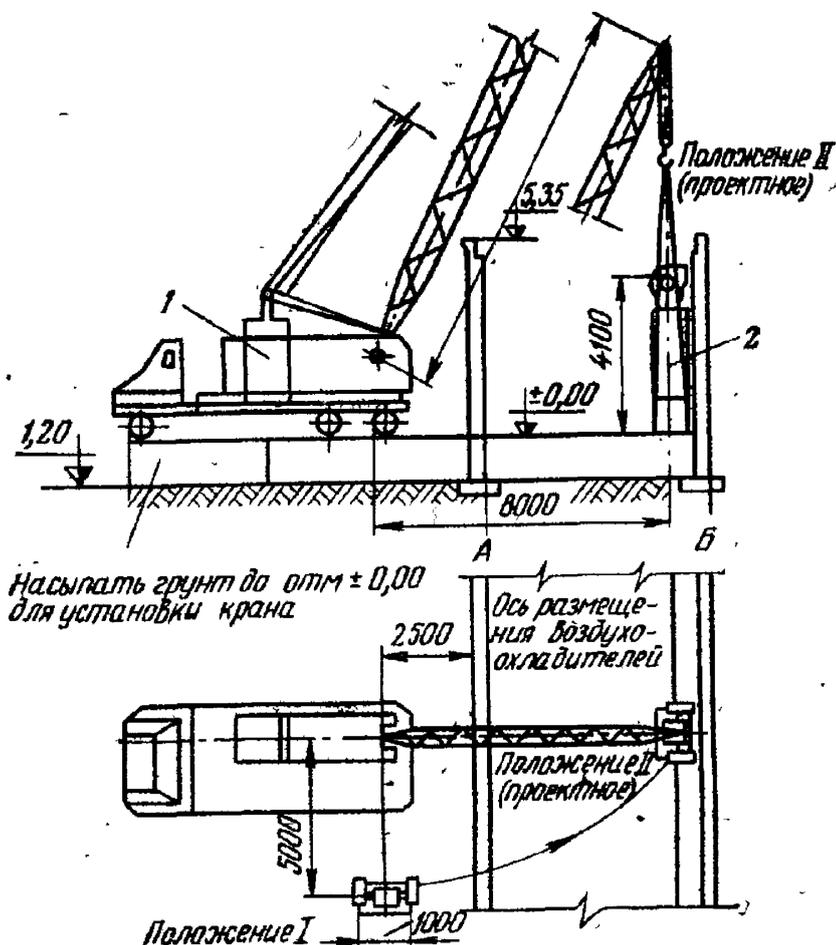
Схема монтажа напольных воздухоохлаждателей поточно-совмещенным способом:
